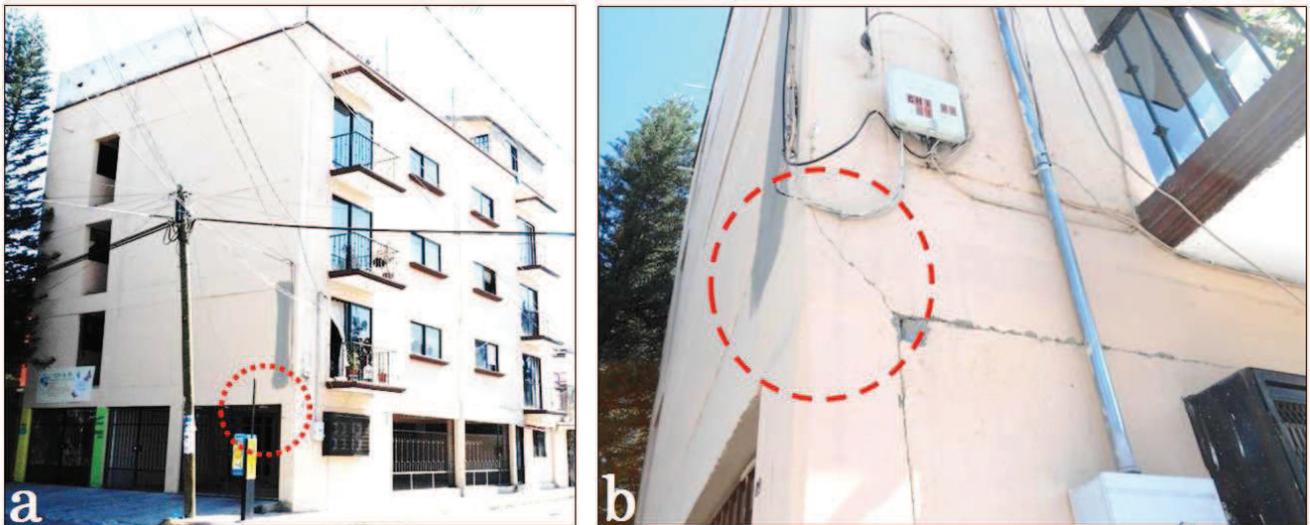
Falla en unión viga columna en edificio reciente con planta baja flexible. Fotografías: Jesús Santos Bautista
